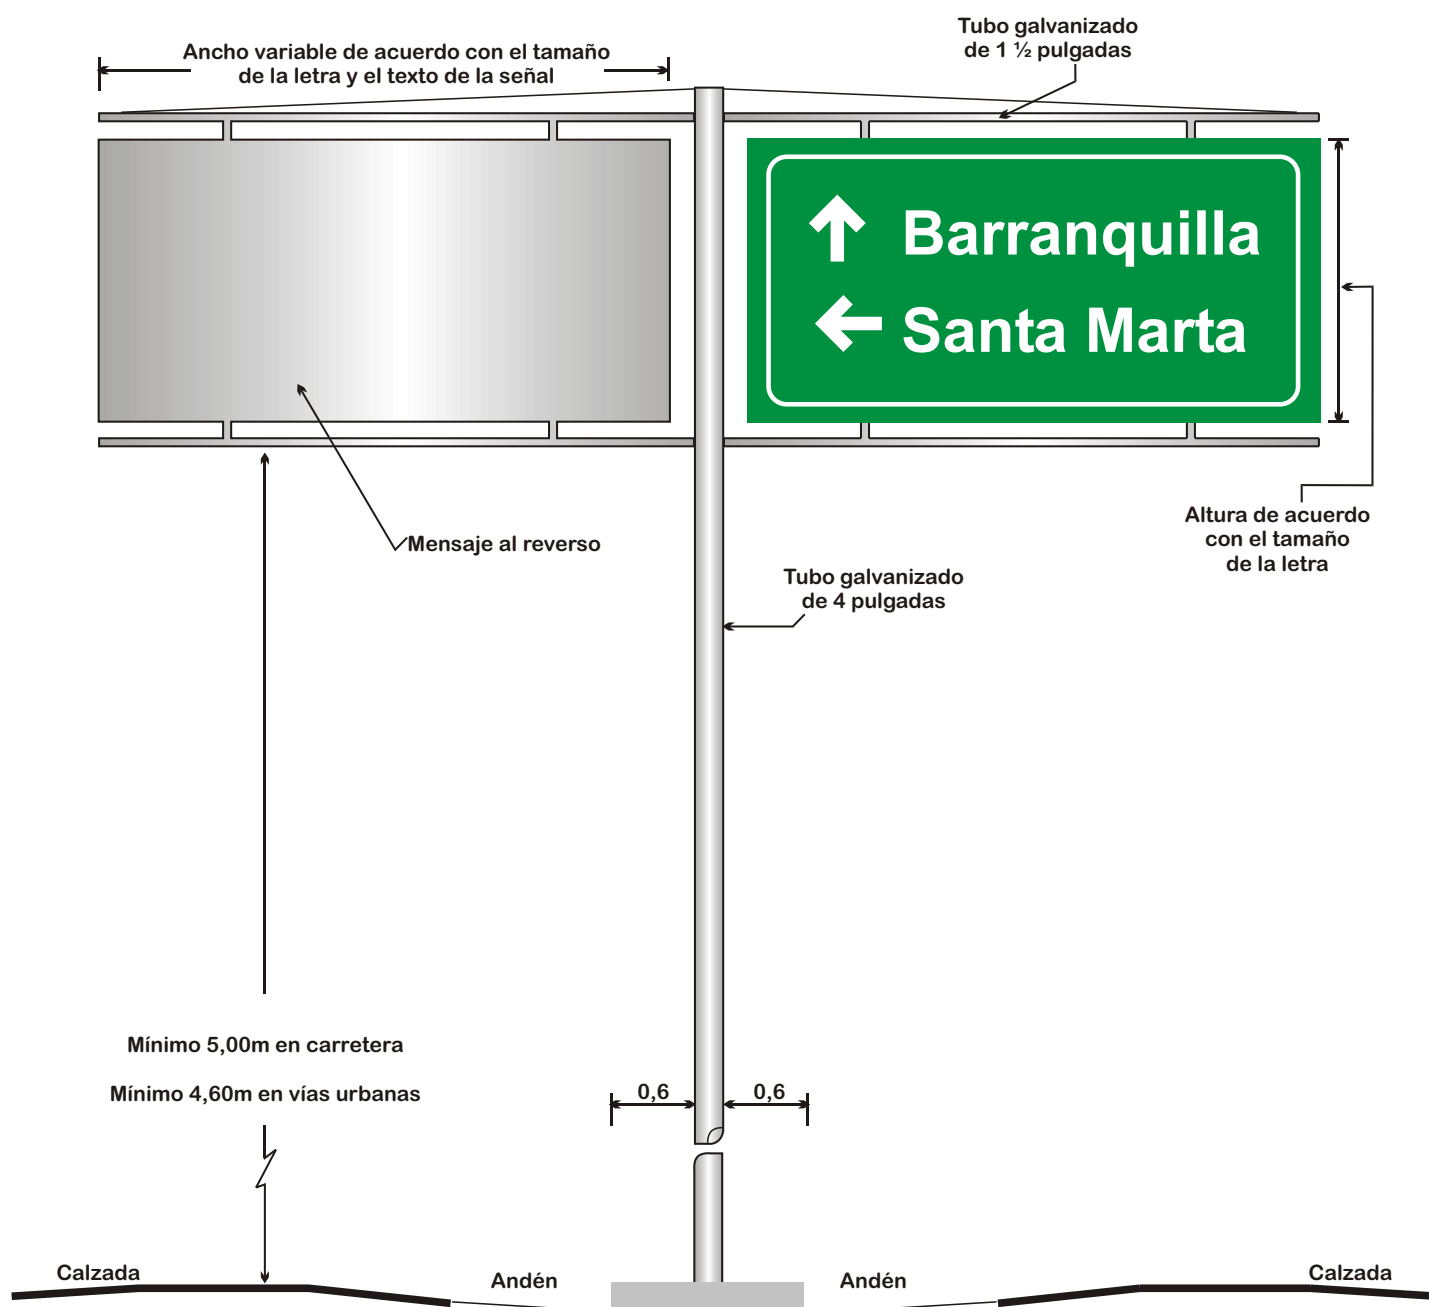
Señal elevada tipo bandera (dimensiones en m)
